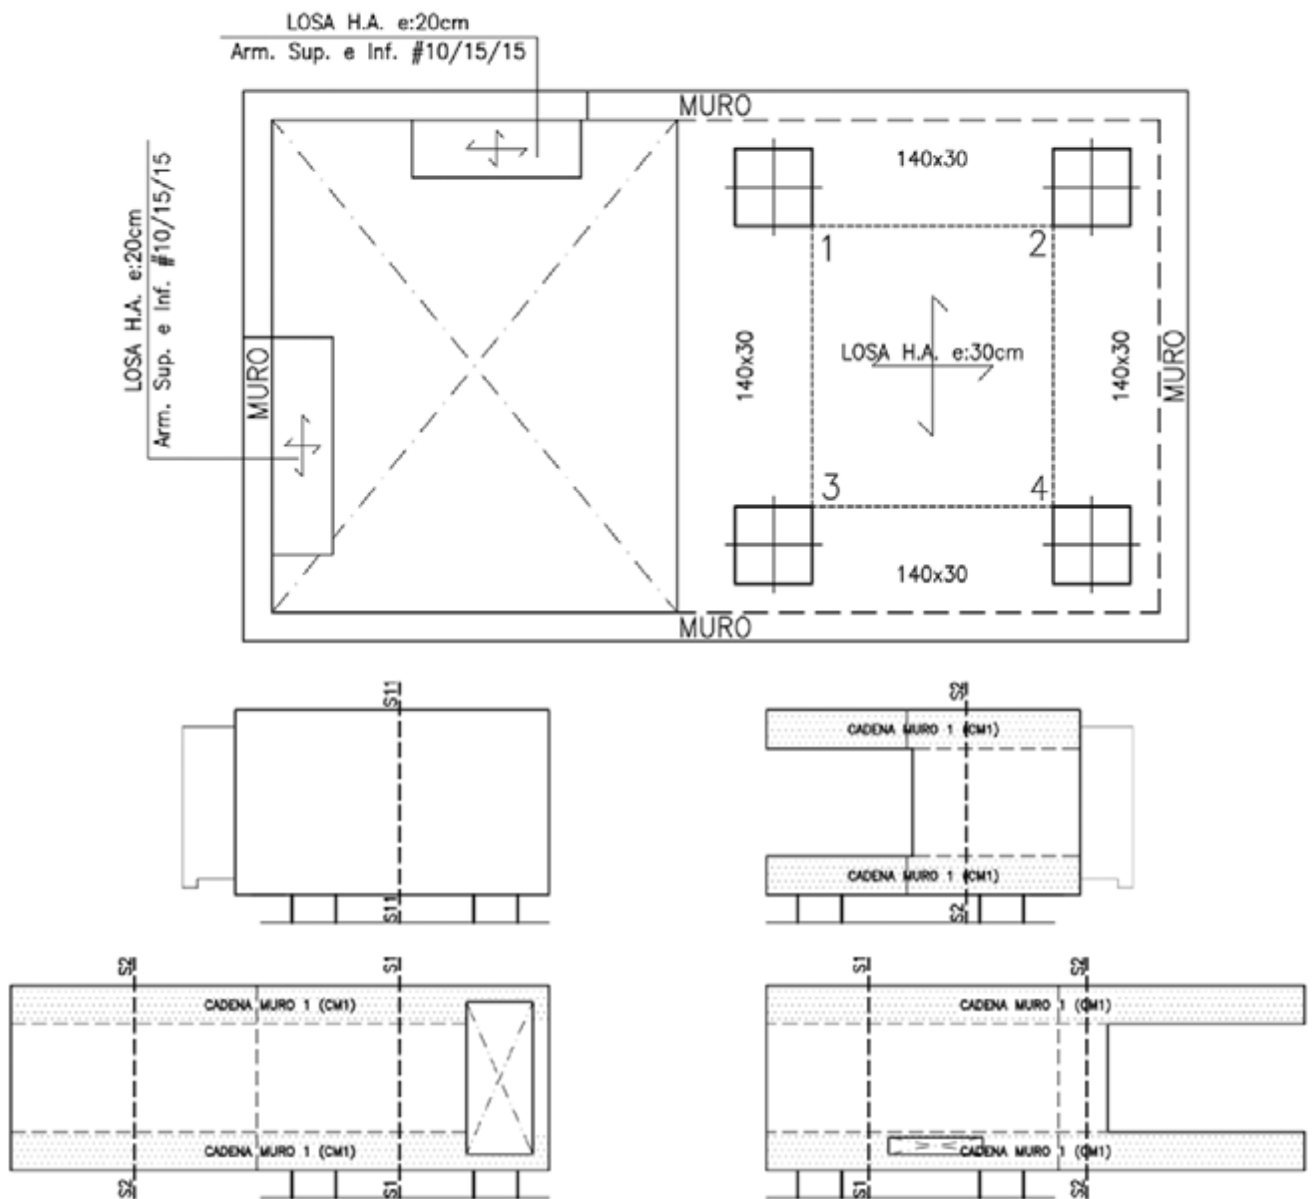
Entramado de forjado de suelo de baja y secciones estructurales de los muros.
